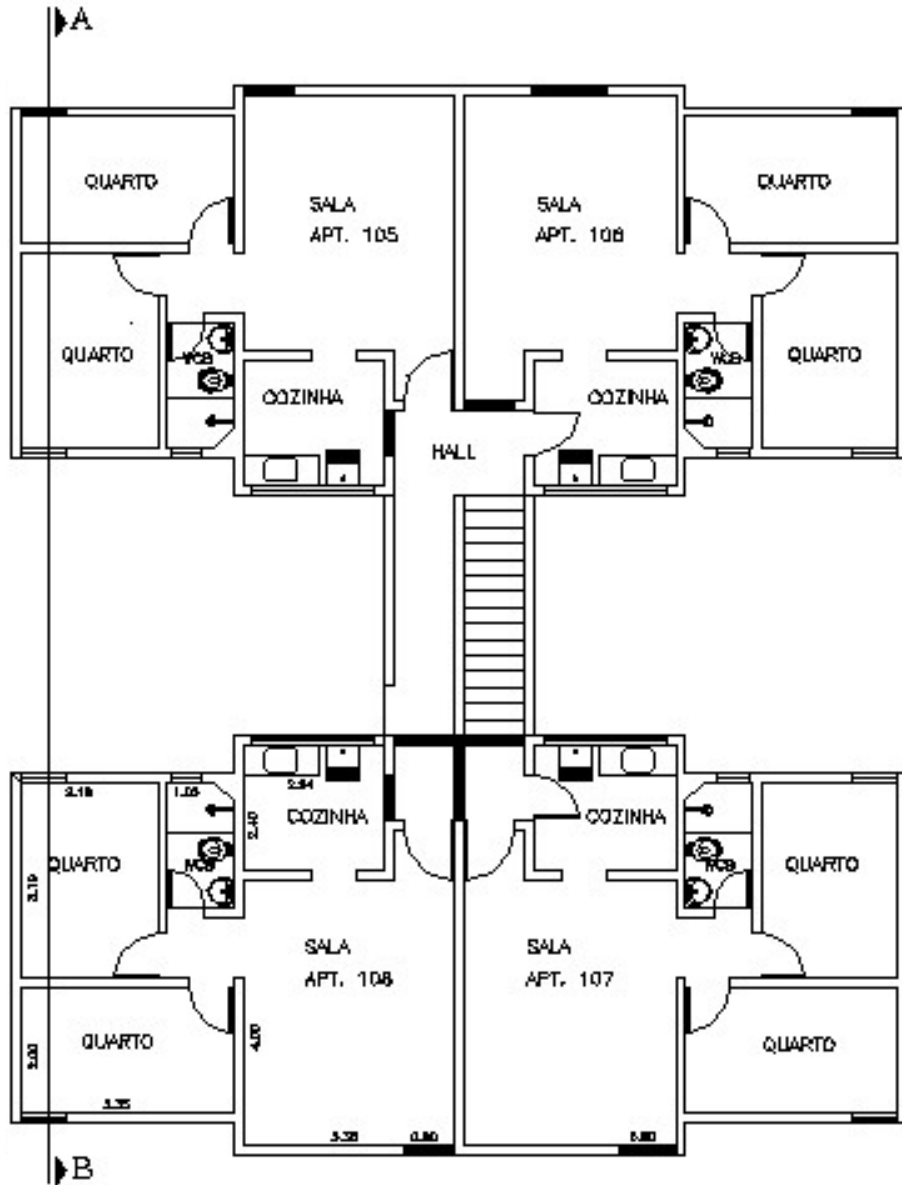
½ planta baixa de pavimento tipo dos edifícios.
